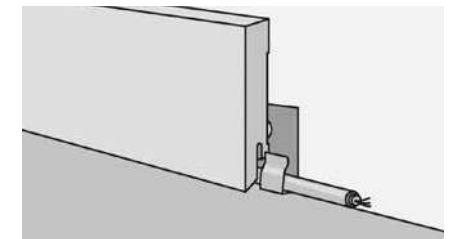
После укладки пола нужно вынуть фиксирующие клинья, а расширительные зазоры закрыть декоративным плинтусом. Плинтус крепится только к стене. Не допускается крепление плинтуса к напольному покрытию.
